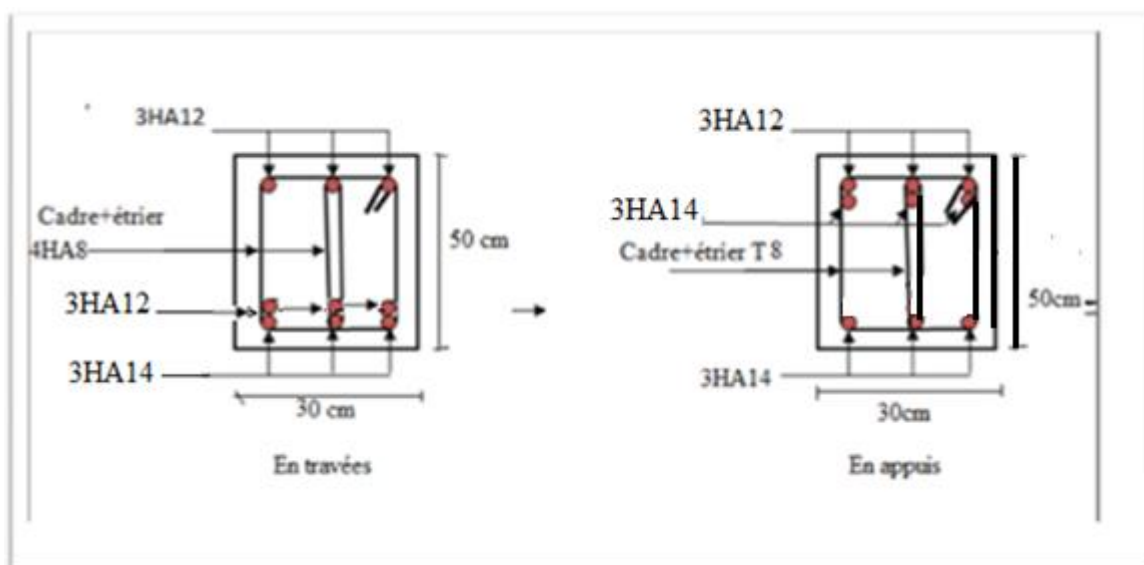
schéma de ferrailage poutres principales étage GRENIER
